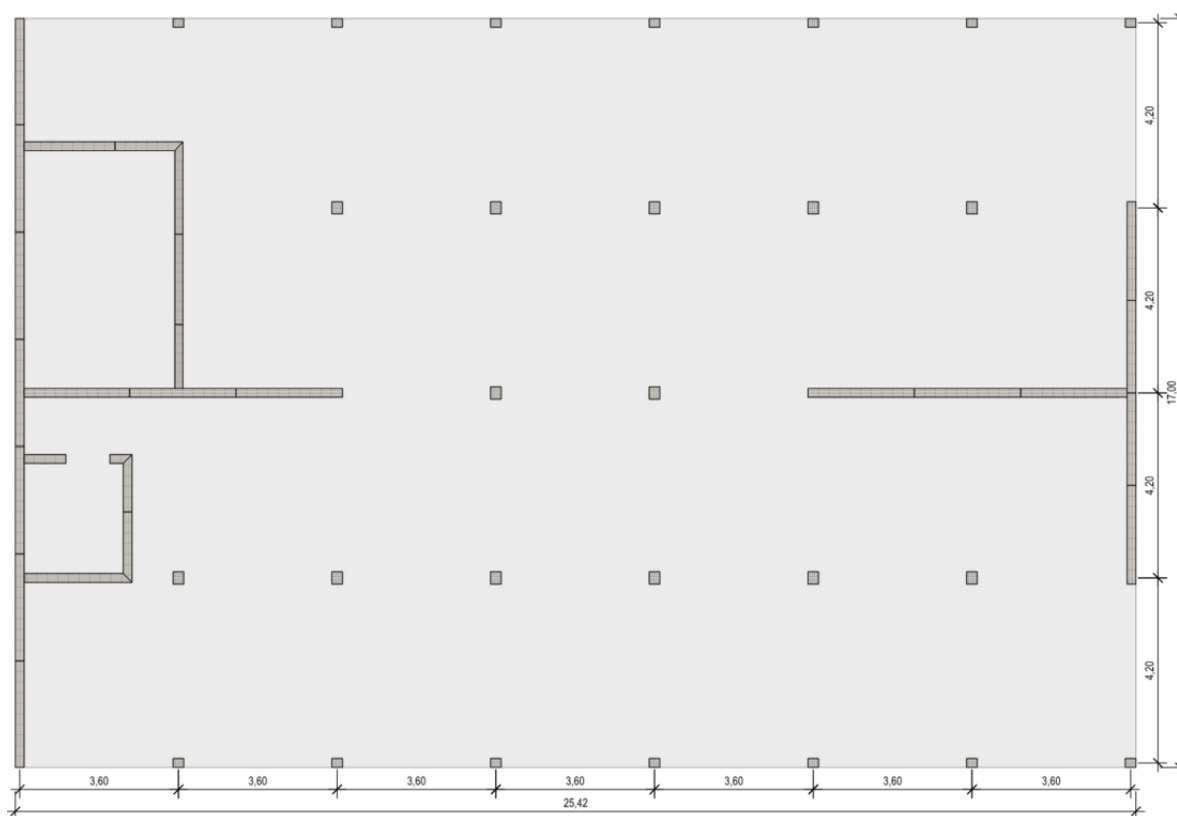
Anordnung der aussteifenden Wände im Grundriss für Konzept 1
